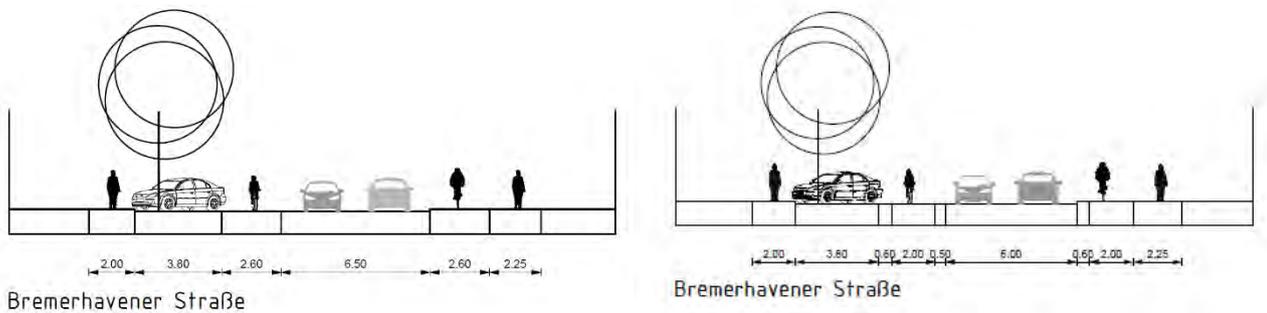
Querschnitt existierende Situation mit Radweg Bremerhavener Straße (Teil 1).
